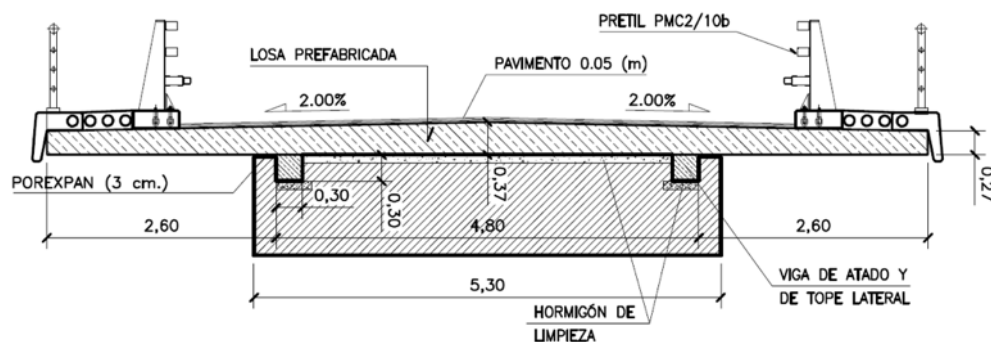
Sección transversal, losa prefabricada y zunchos de conexión. ^[18] (Barrientos)
